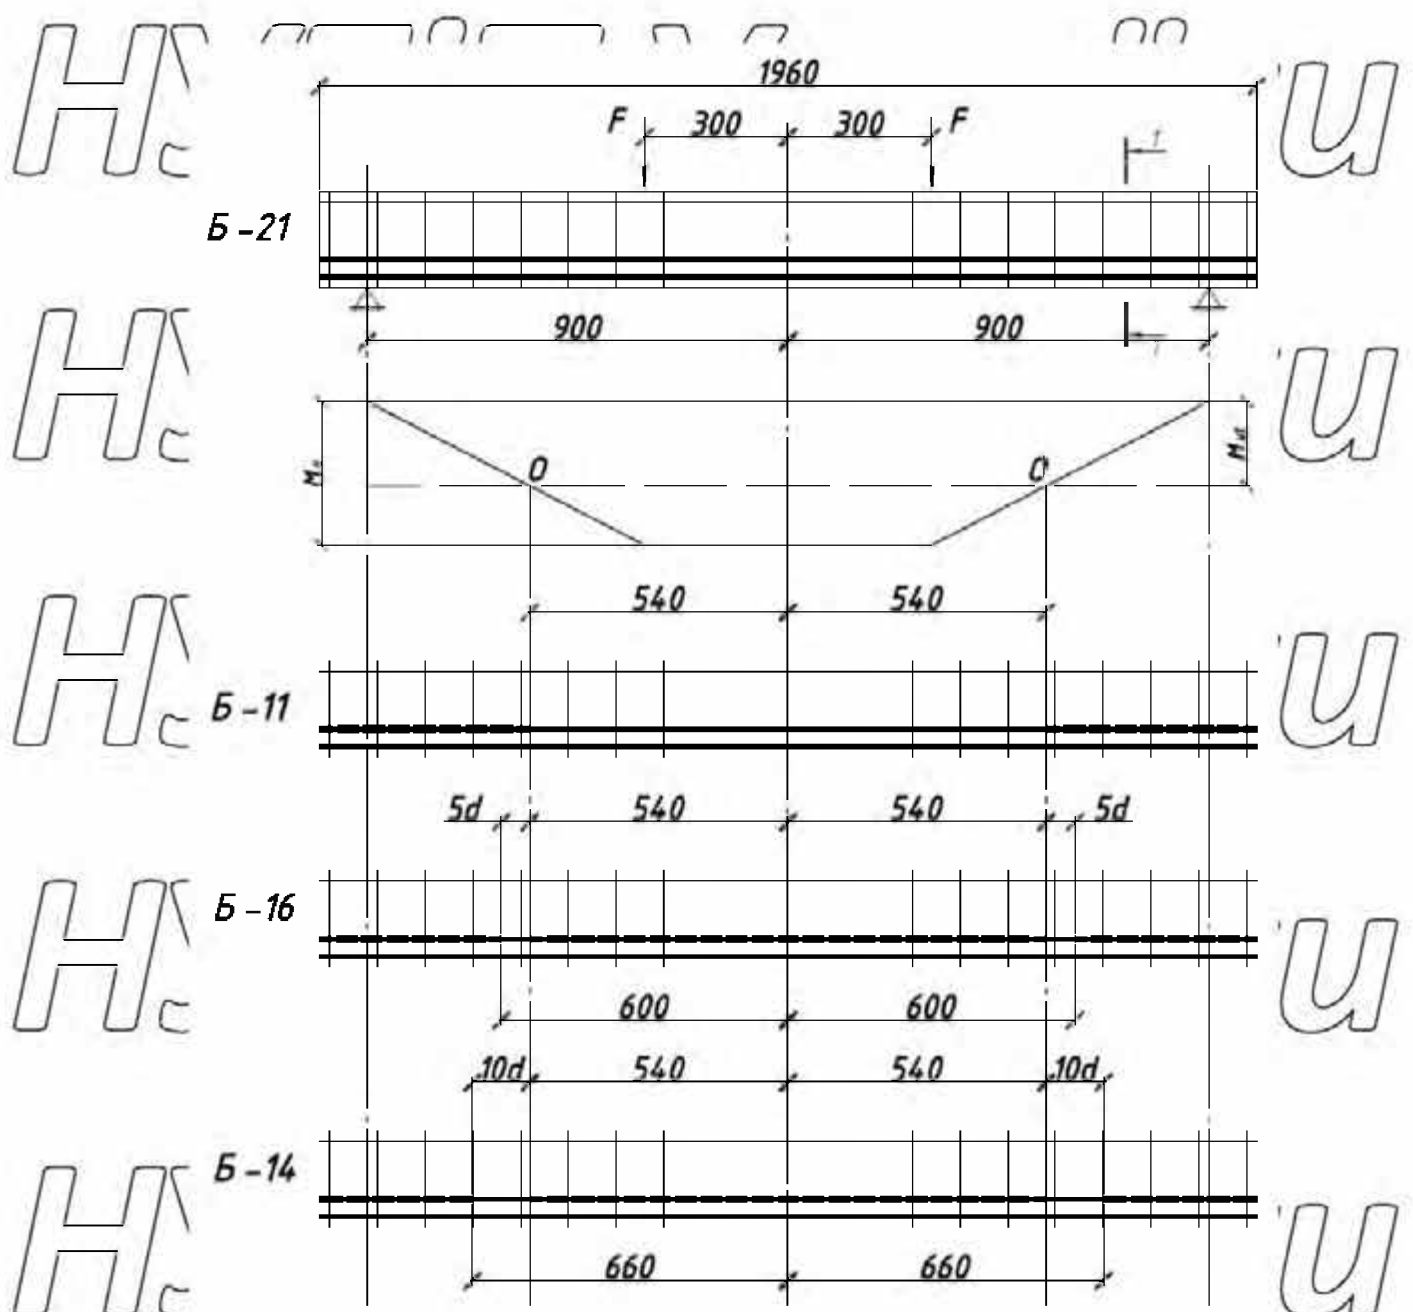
План армування балки Б-21 та схеми каркасів для балок Б-11, Б-14, Б-16
